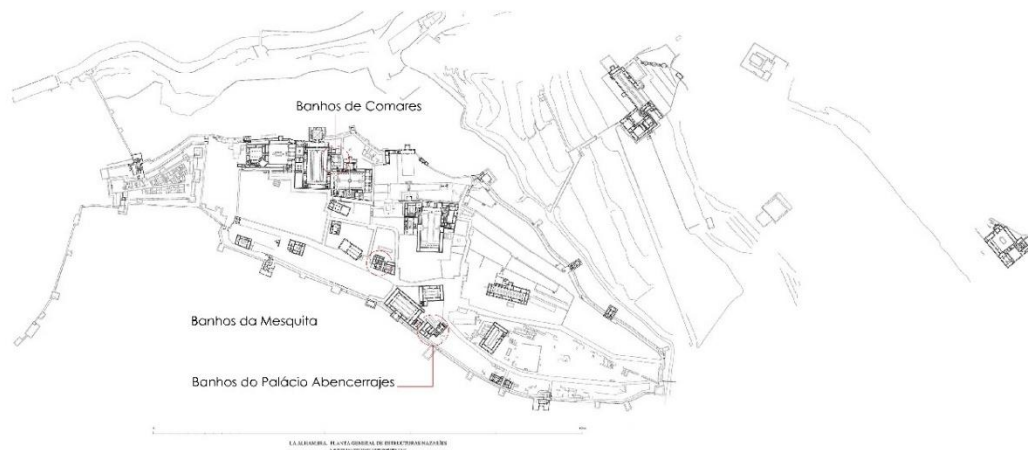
PLANTA DE LA ALHAMBRA, GRANADA, ESPANHA
